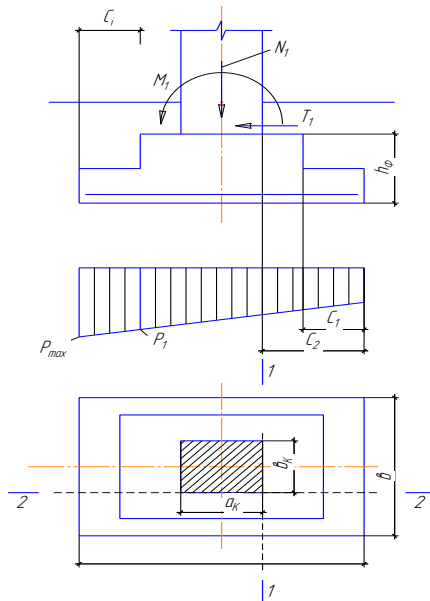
Схема для розрахунку фундаменту на згинання.
